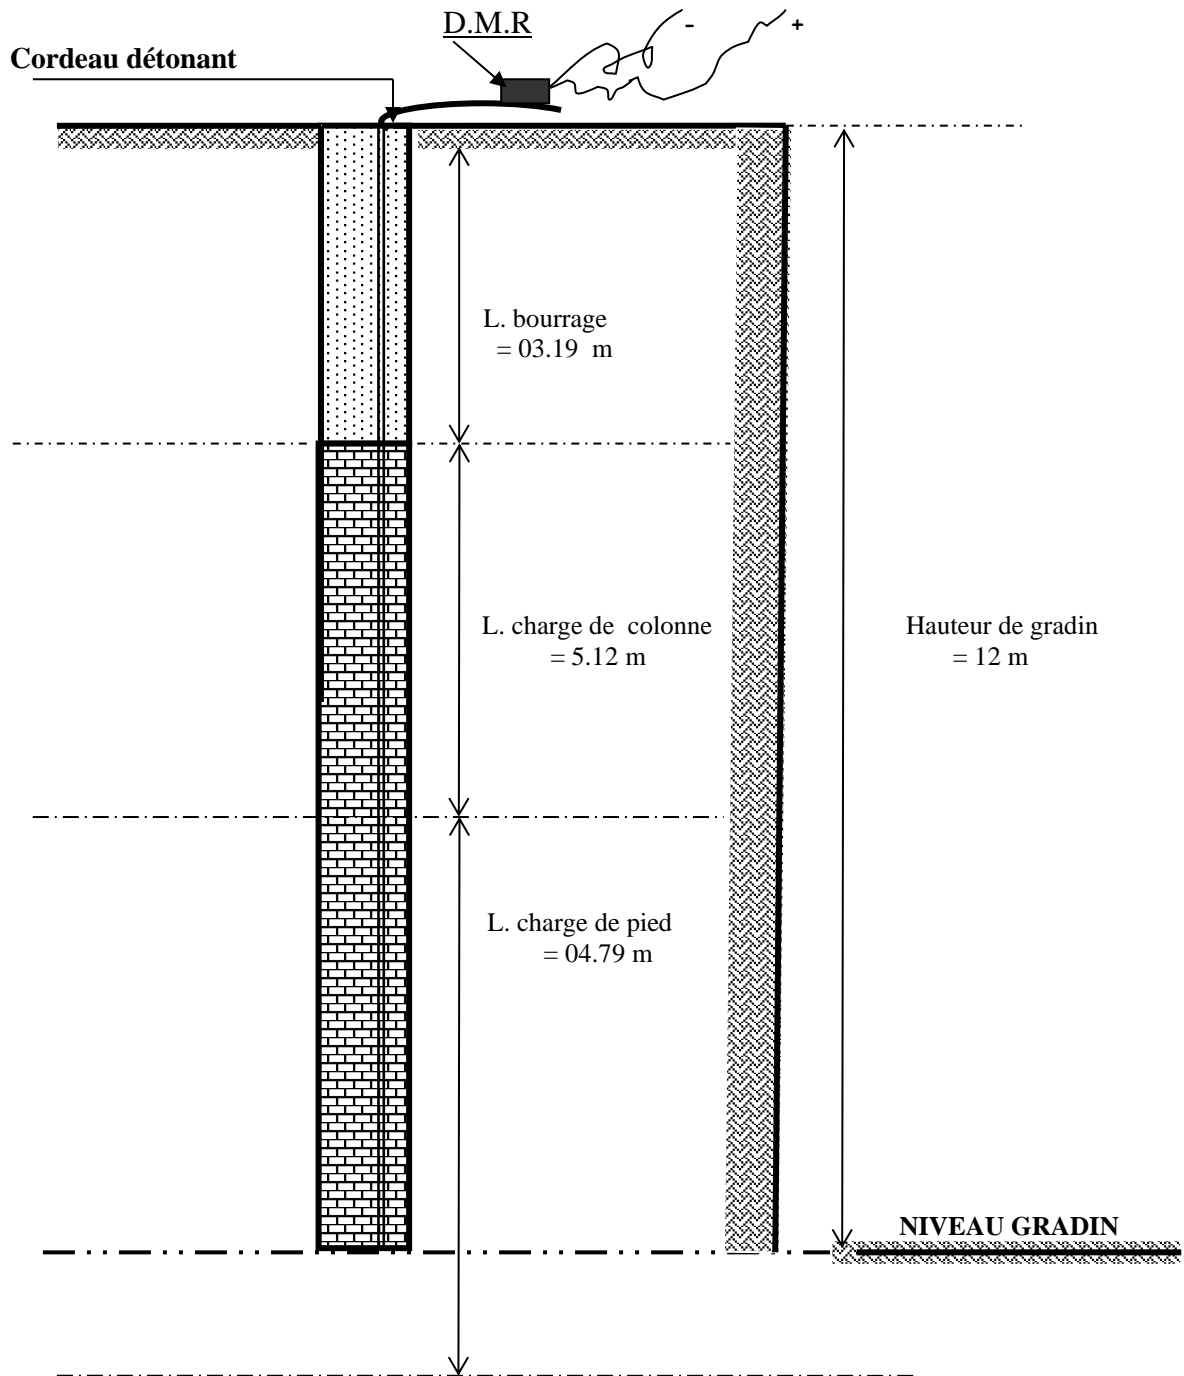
Coupe verticale de profondeur du trou de diamètre 102 mm.
